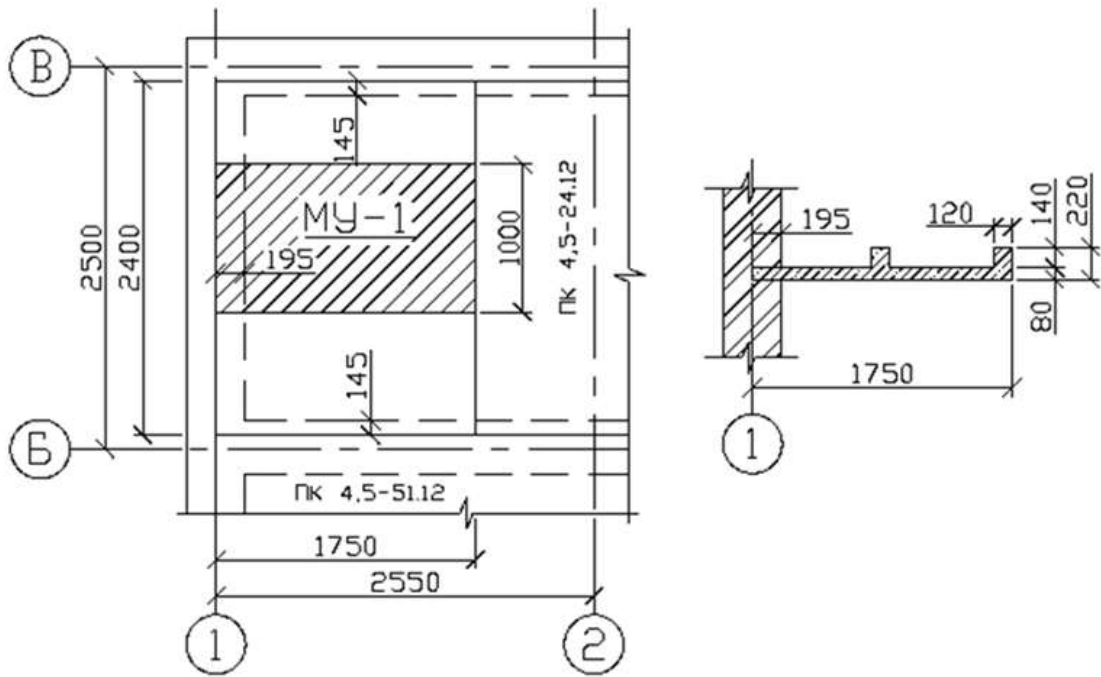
Фрагмент схеми розташування перекриття
